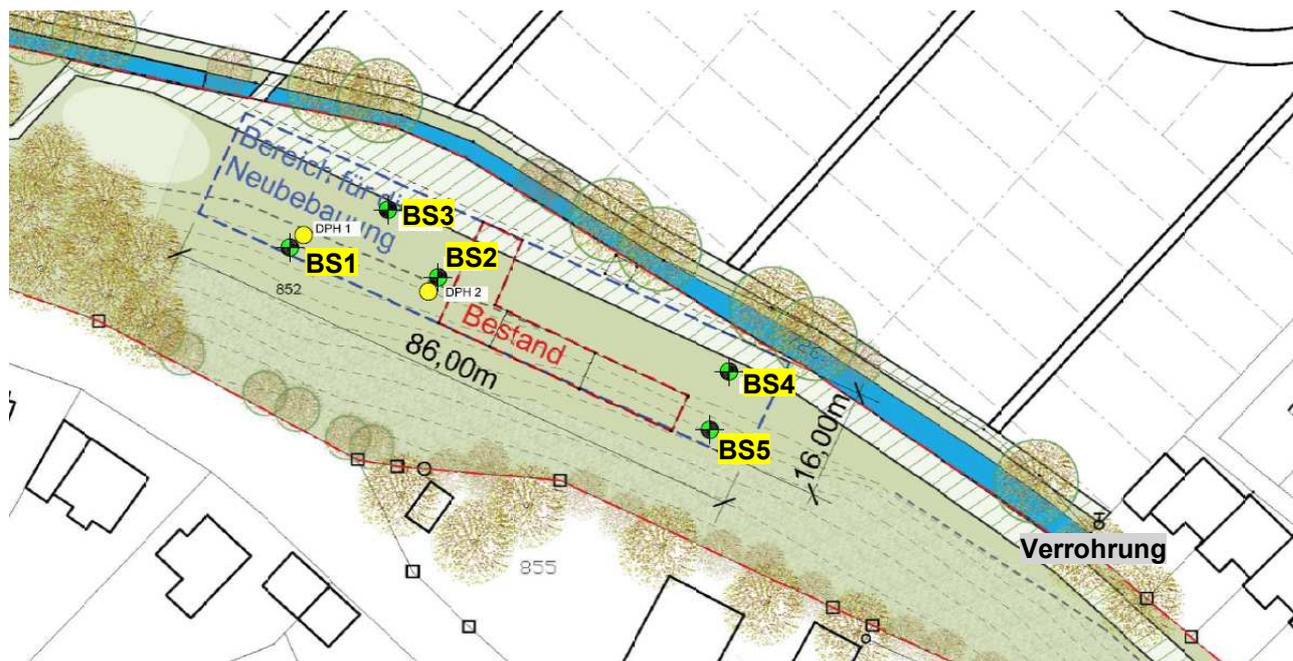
Lage der durchgeführten Sondierbohrungen (IGA Augsburg)
